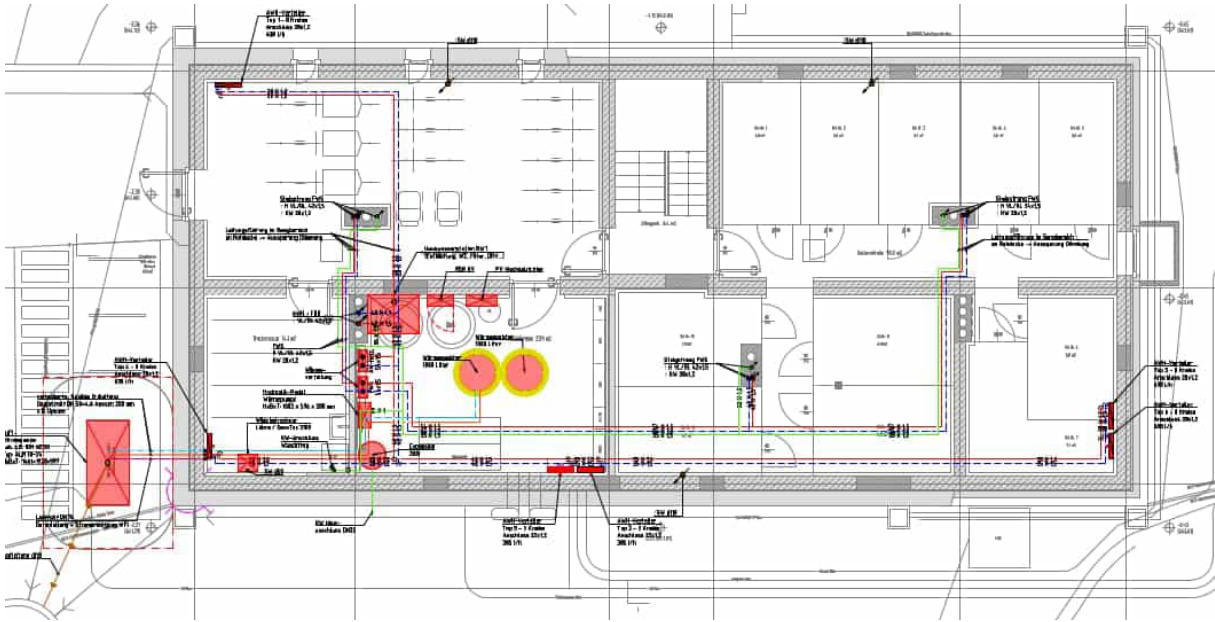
Grundriss KG mit neuem Haustechnikraum und Luft-Wärmepumpe; Planungsteam E-Plus
